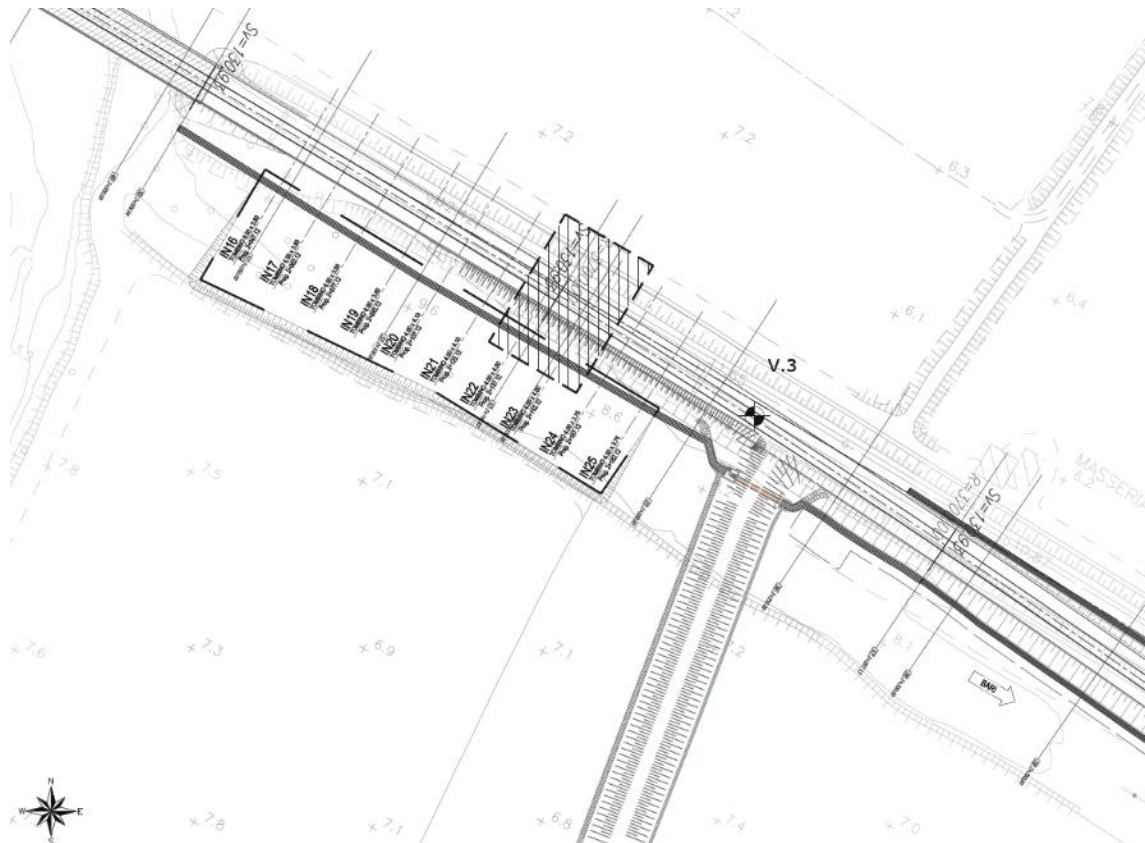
Scatolari in c.a. IN22 ed IN23 – Vista Planimetrica
